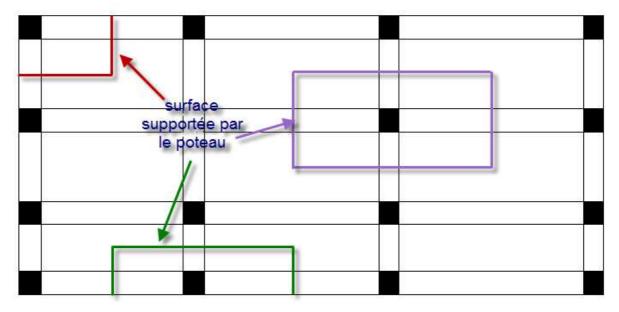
La surface intervenant au calcul de la descente de charges d'un poteau.
